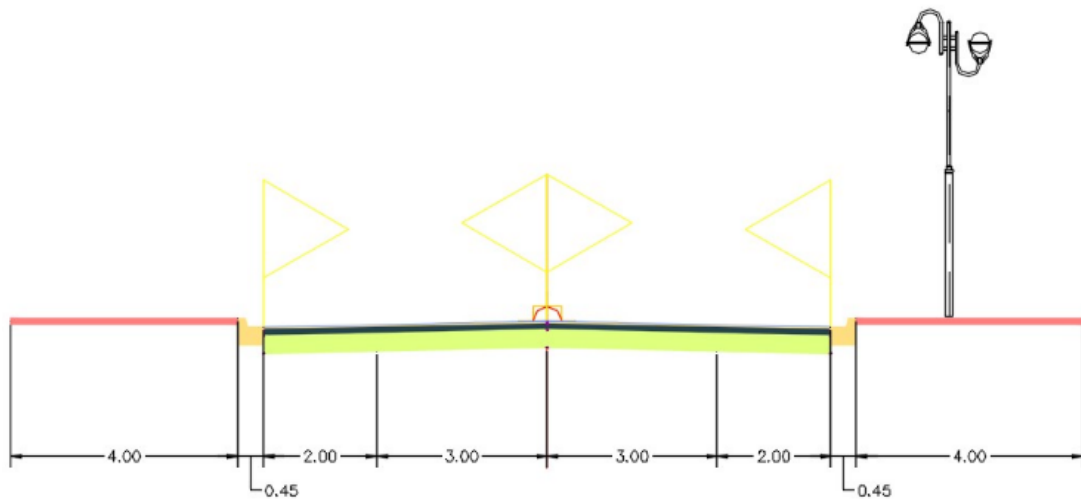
Sección transversal la calle Rondón (Tramo 1).
